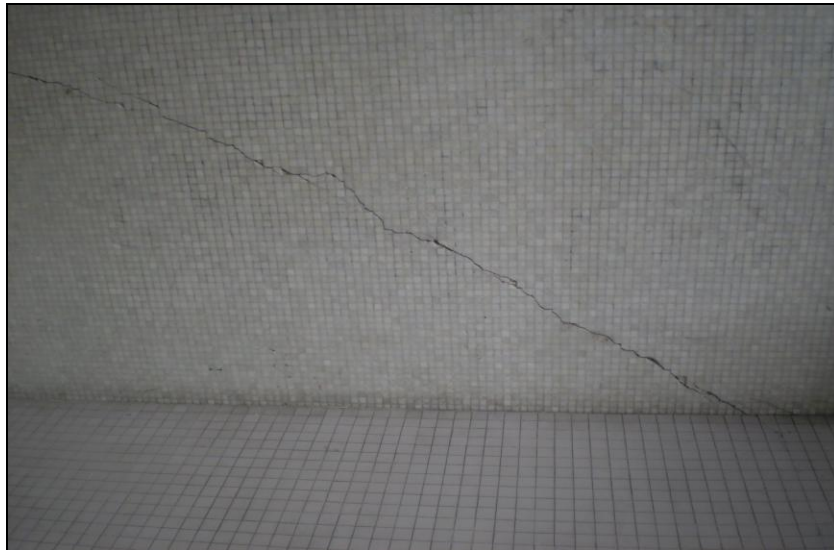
Agrietamiento vertical en la fachada norte.
